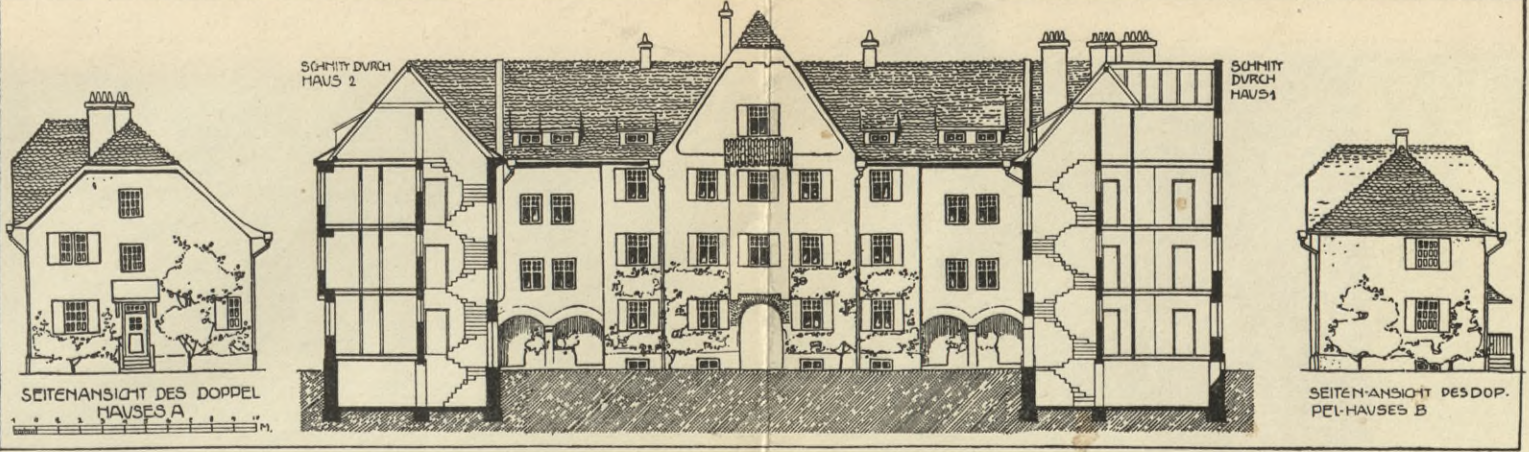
Wohnhof im Hauptgebäude, zweistöckig umbaut; bestehend aus
